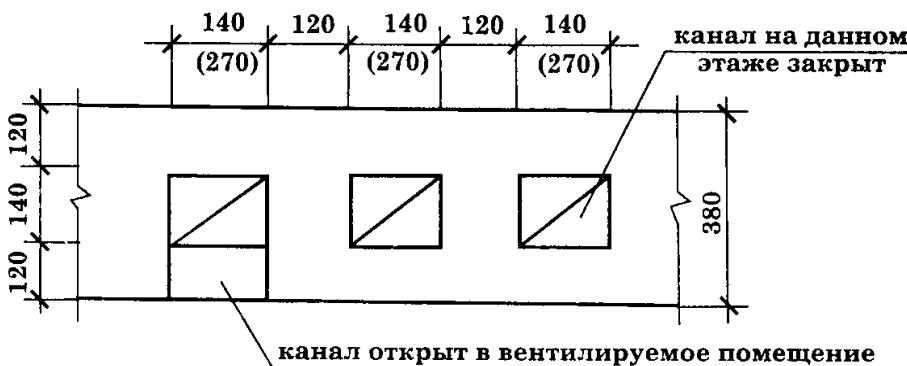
Размещение вентиляционных каналов во внутренних стенах.
